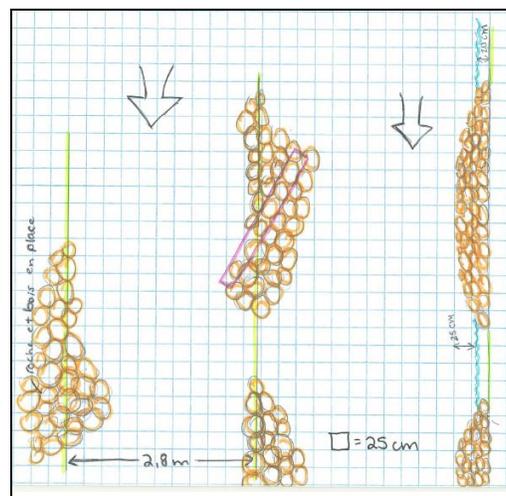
Plan détaillé du déflecteur P-035 du ruisseau des Pères
